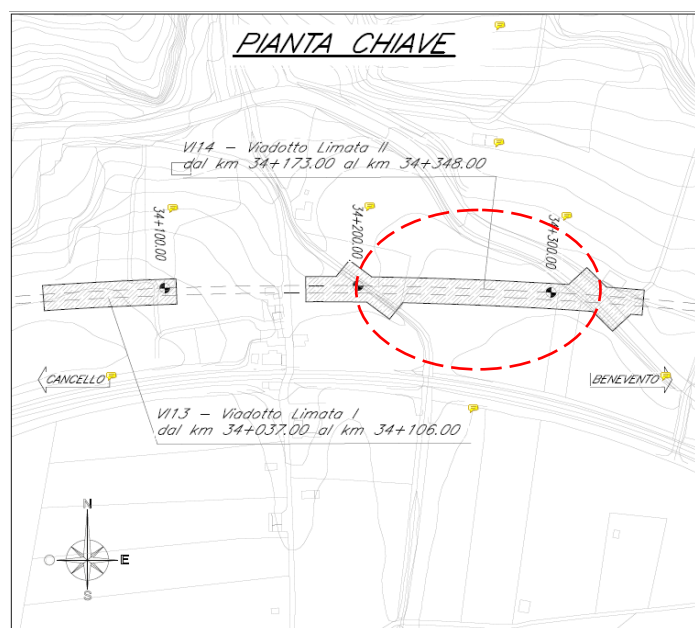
Stralcio planimetrico del Viadotto Limata II – VI14 - dettaglio del concio numero 6, L=44m
